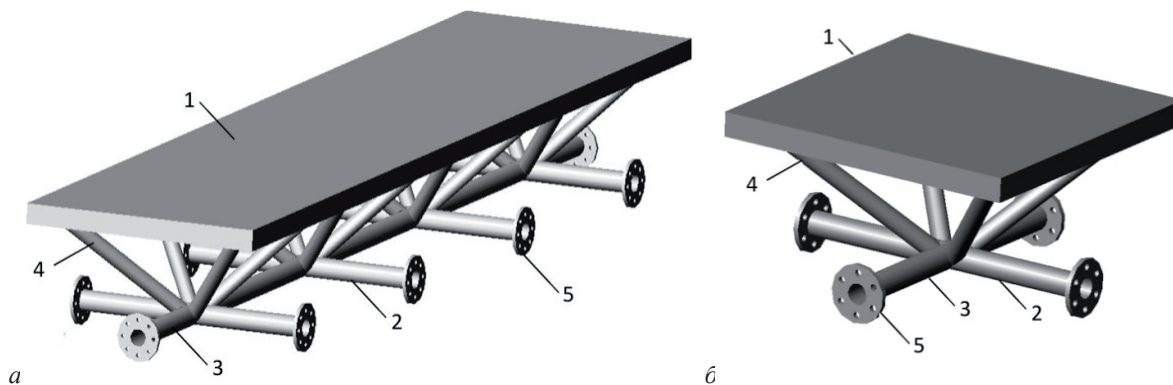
Елементи сталезалізобетонного структурного кріплення: а) лінійний елемент; б) окремий елемент; 1 – сталезалізобетонна плита; 2 – поперечні сталезалізобетонні стрижні; 3 – поздовжні сталезалізобетонні стрижні; 4 – похилі сталезалізобетонні стрижні; 5 – фланець
